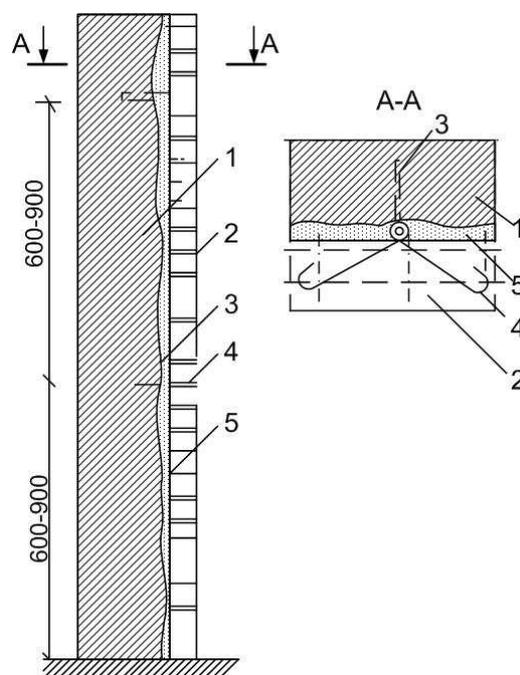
Восстановление облицовки с креплением к старой кладке стальными усами: 1 – старая кладка; 2 – облицовка; 3 – штырь; 4 – усы или арматурные сетки; 5 – цементный раствор
